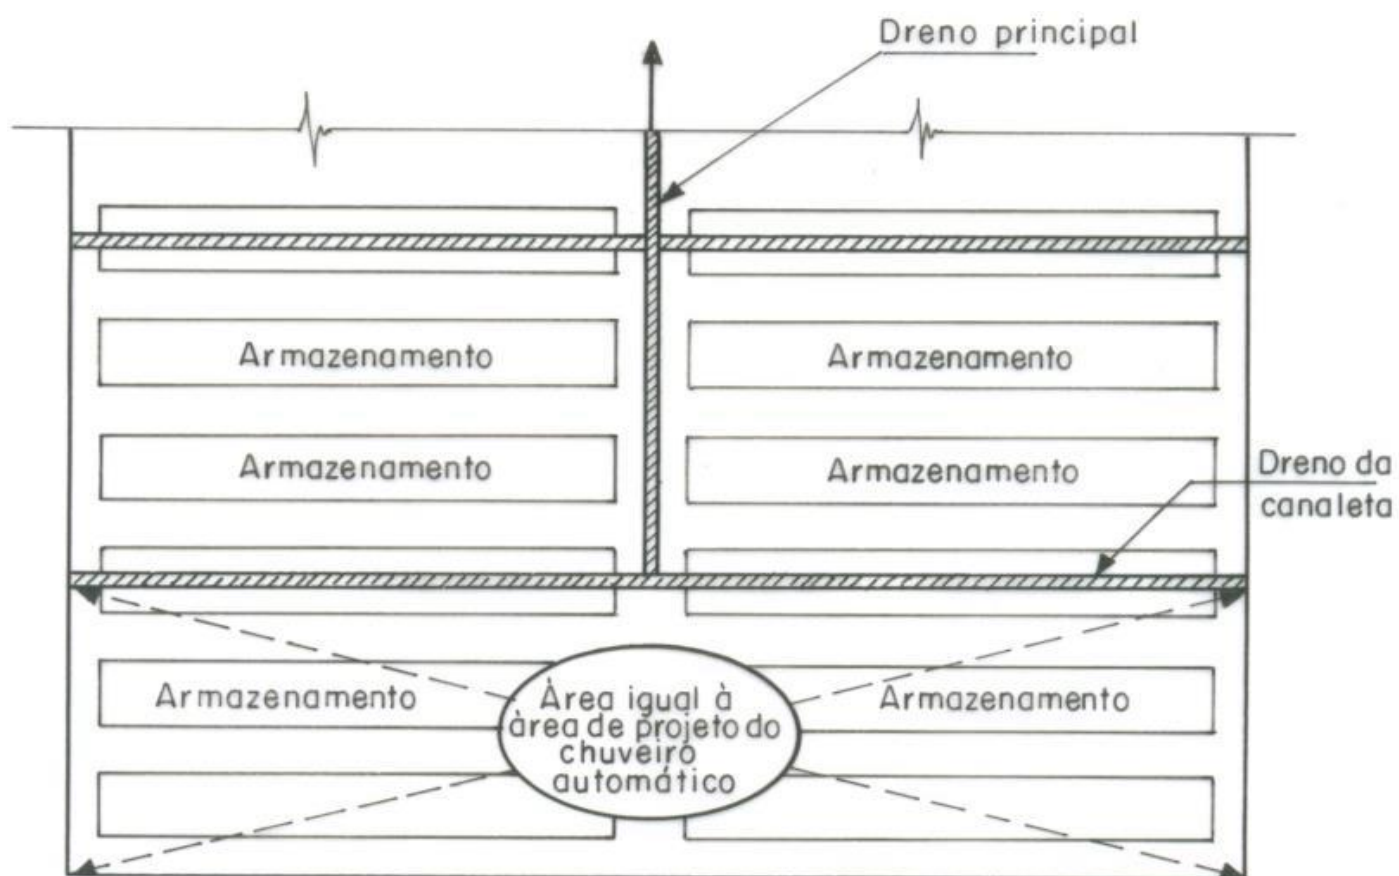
Vista em planta de controle de líquidos em armazéns.
